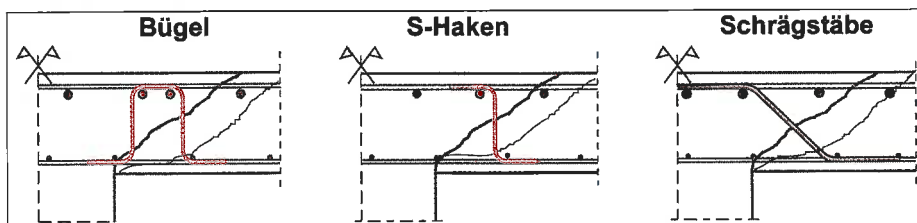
Schubbewehrung im Durchstanzbereich nach DIN 1045
